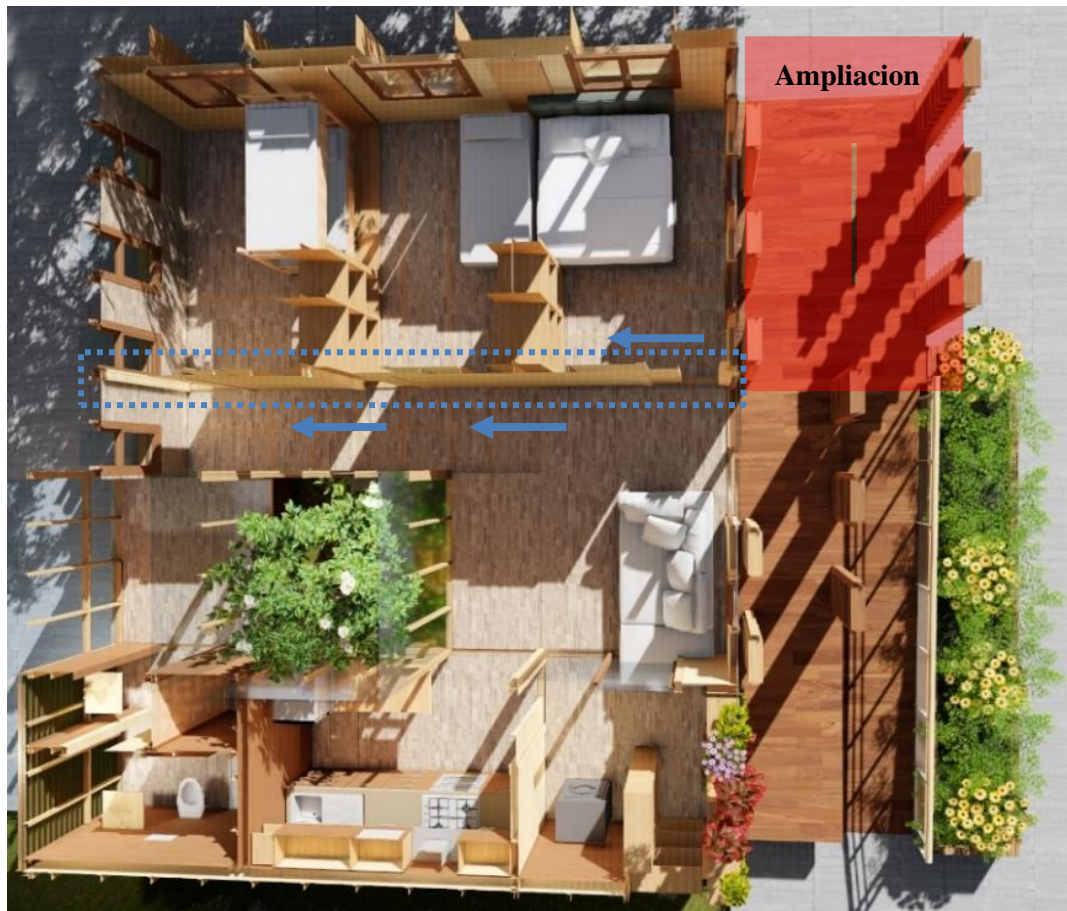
Adaptabilidad planta Nocturna, Fuente: Propia. (2019)
